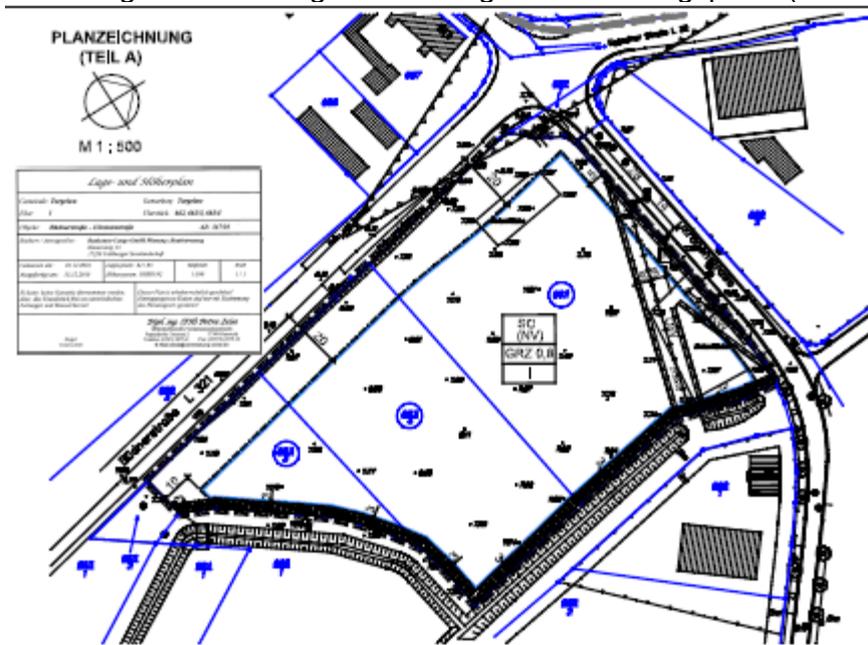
Darstellung 3. Änderung des Bebauungsplans (ohne Maßstab)
